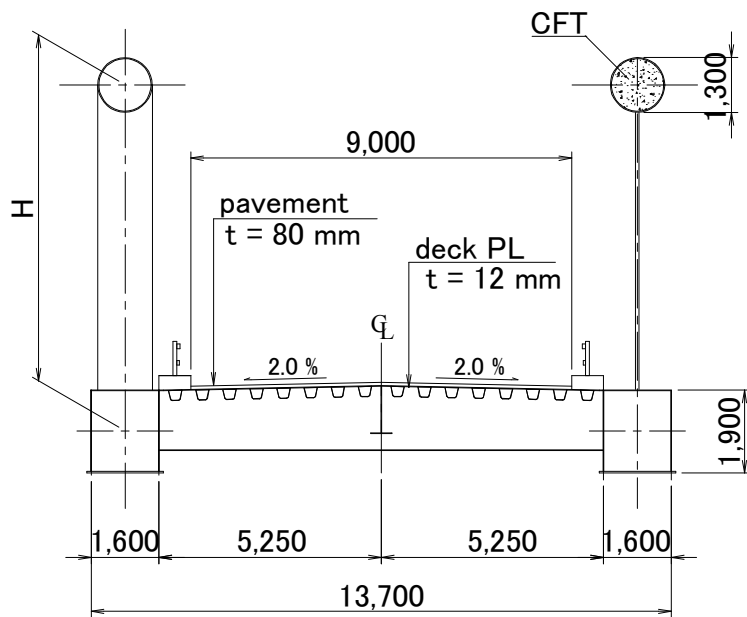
CFT 補剛アーチ橋 断面図 (mm)
